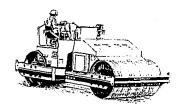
COMPACTADOR DE RODILLOS VIBRATORIOS
